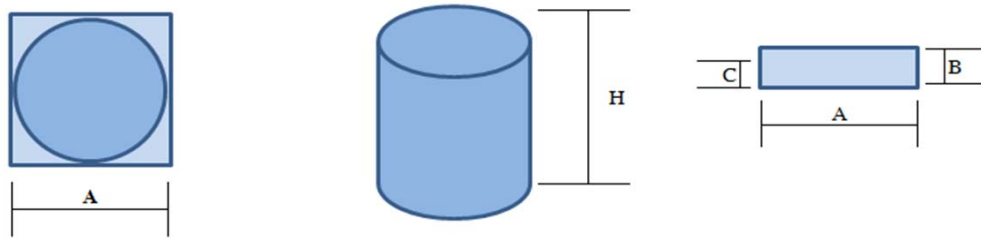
Ilustração esquemática da base do tanque de armazenamento
